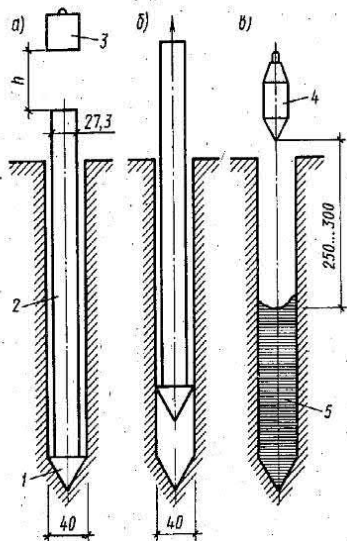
Схема устройства грунтовых свай способом сердечника:
